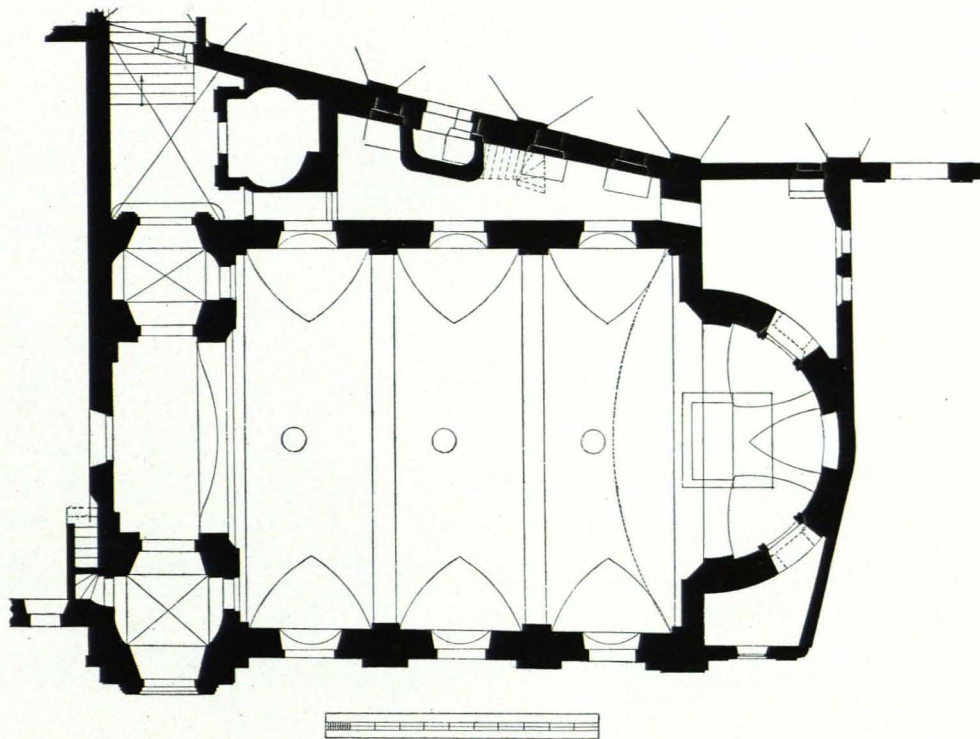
Sebastianskirche, Grundriß 1 : 300 (S. 125)
